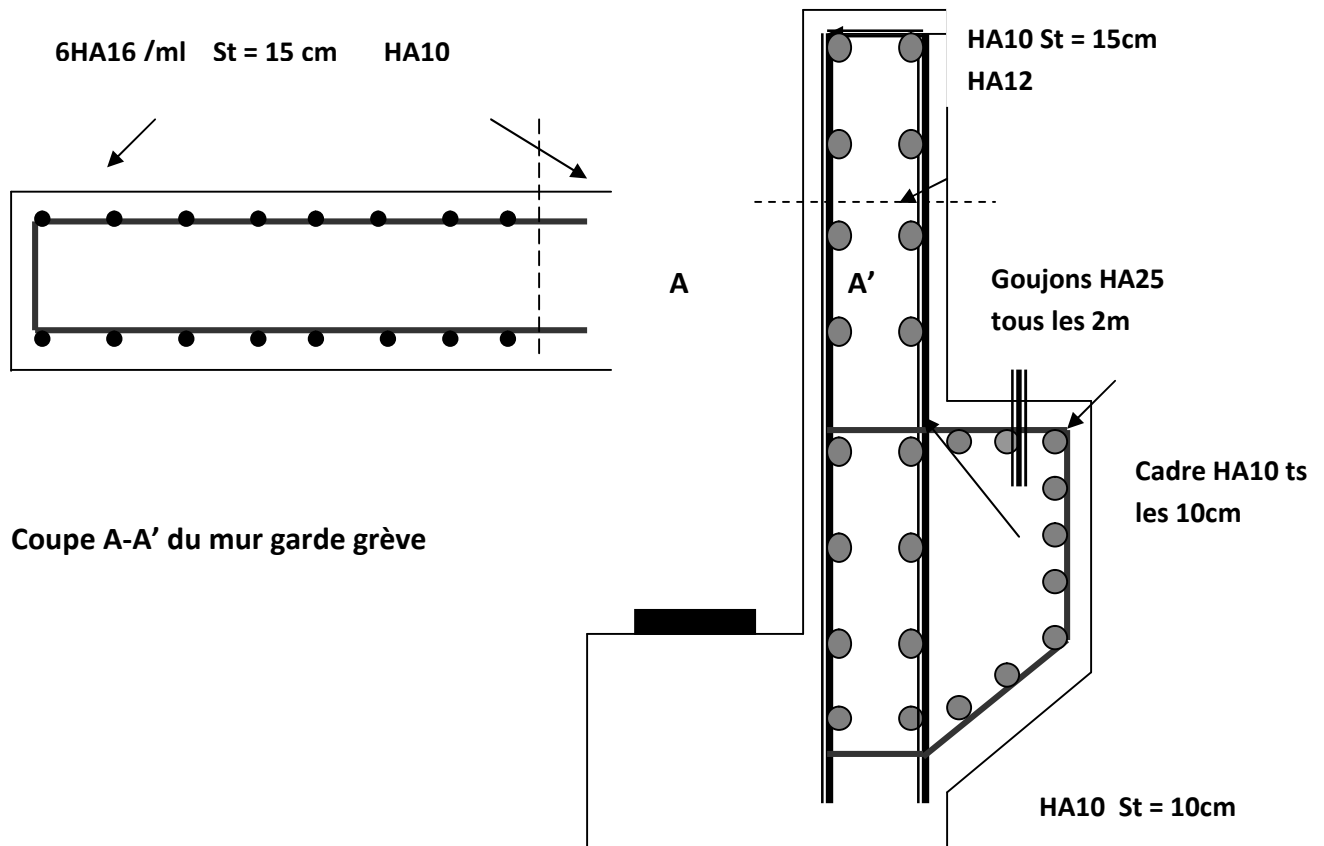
1.Ferrailage du mur garde grève et du corbeau d'appui .
